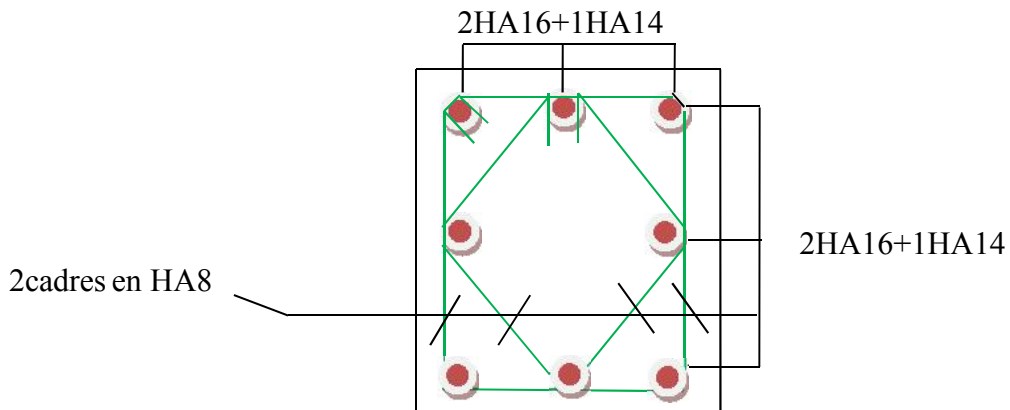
Coupe verticale sur poteau (40x40)cm²
